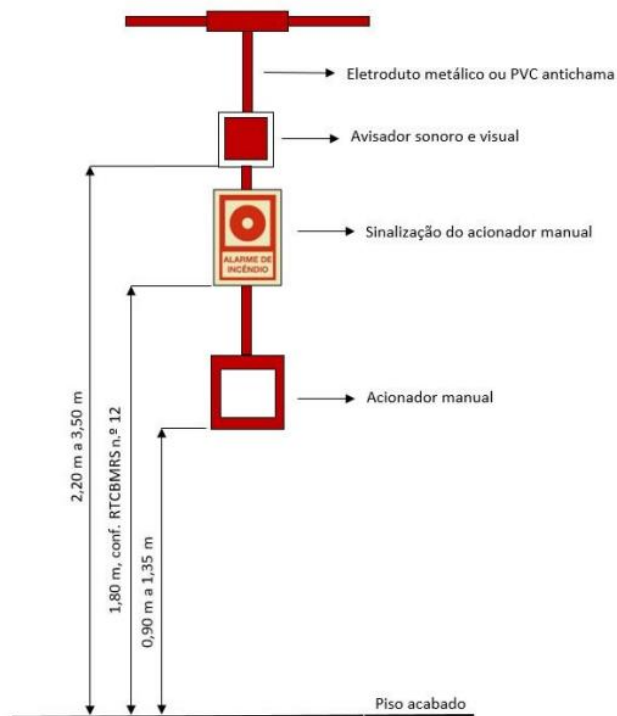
Acionador manual com avisador em instalação sobreposta à parede
